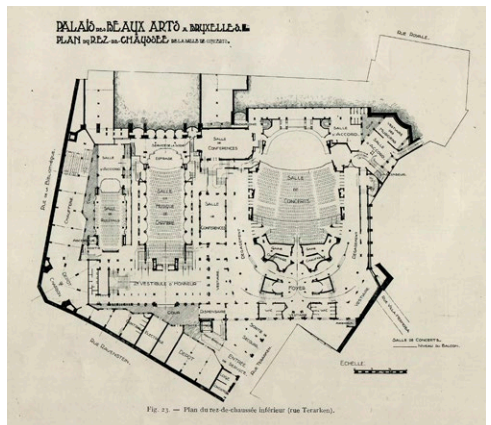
Plan de rez-de-chaussée inférieur (rue Terarken).
